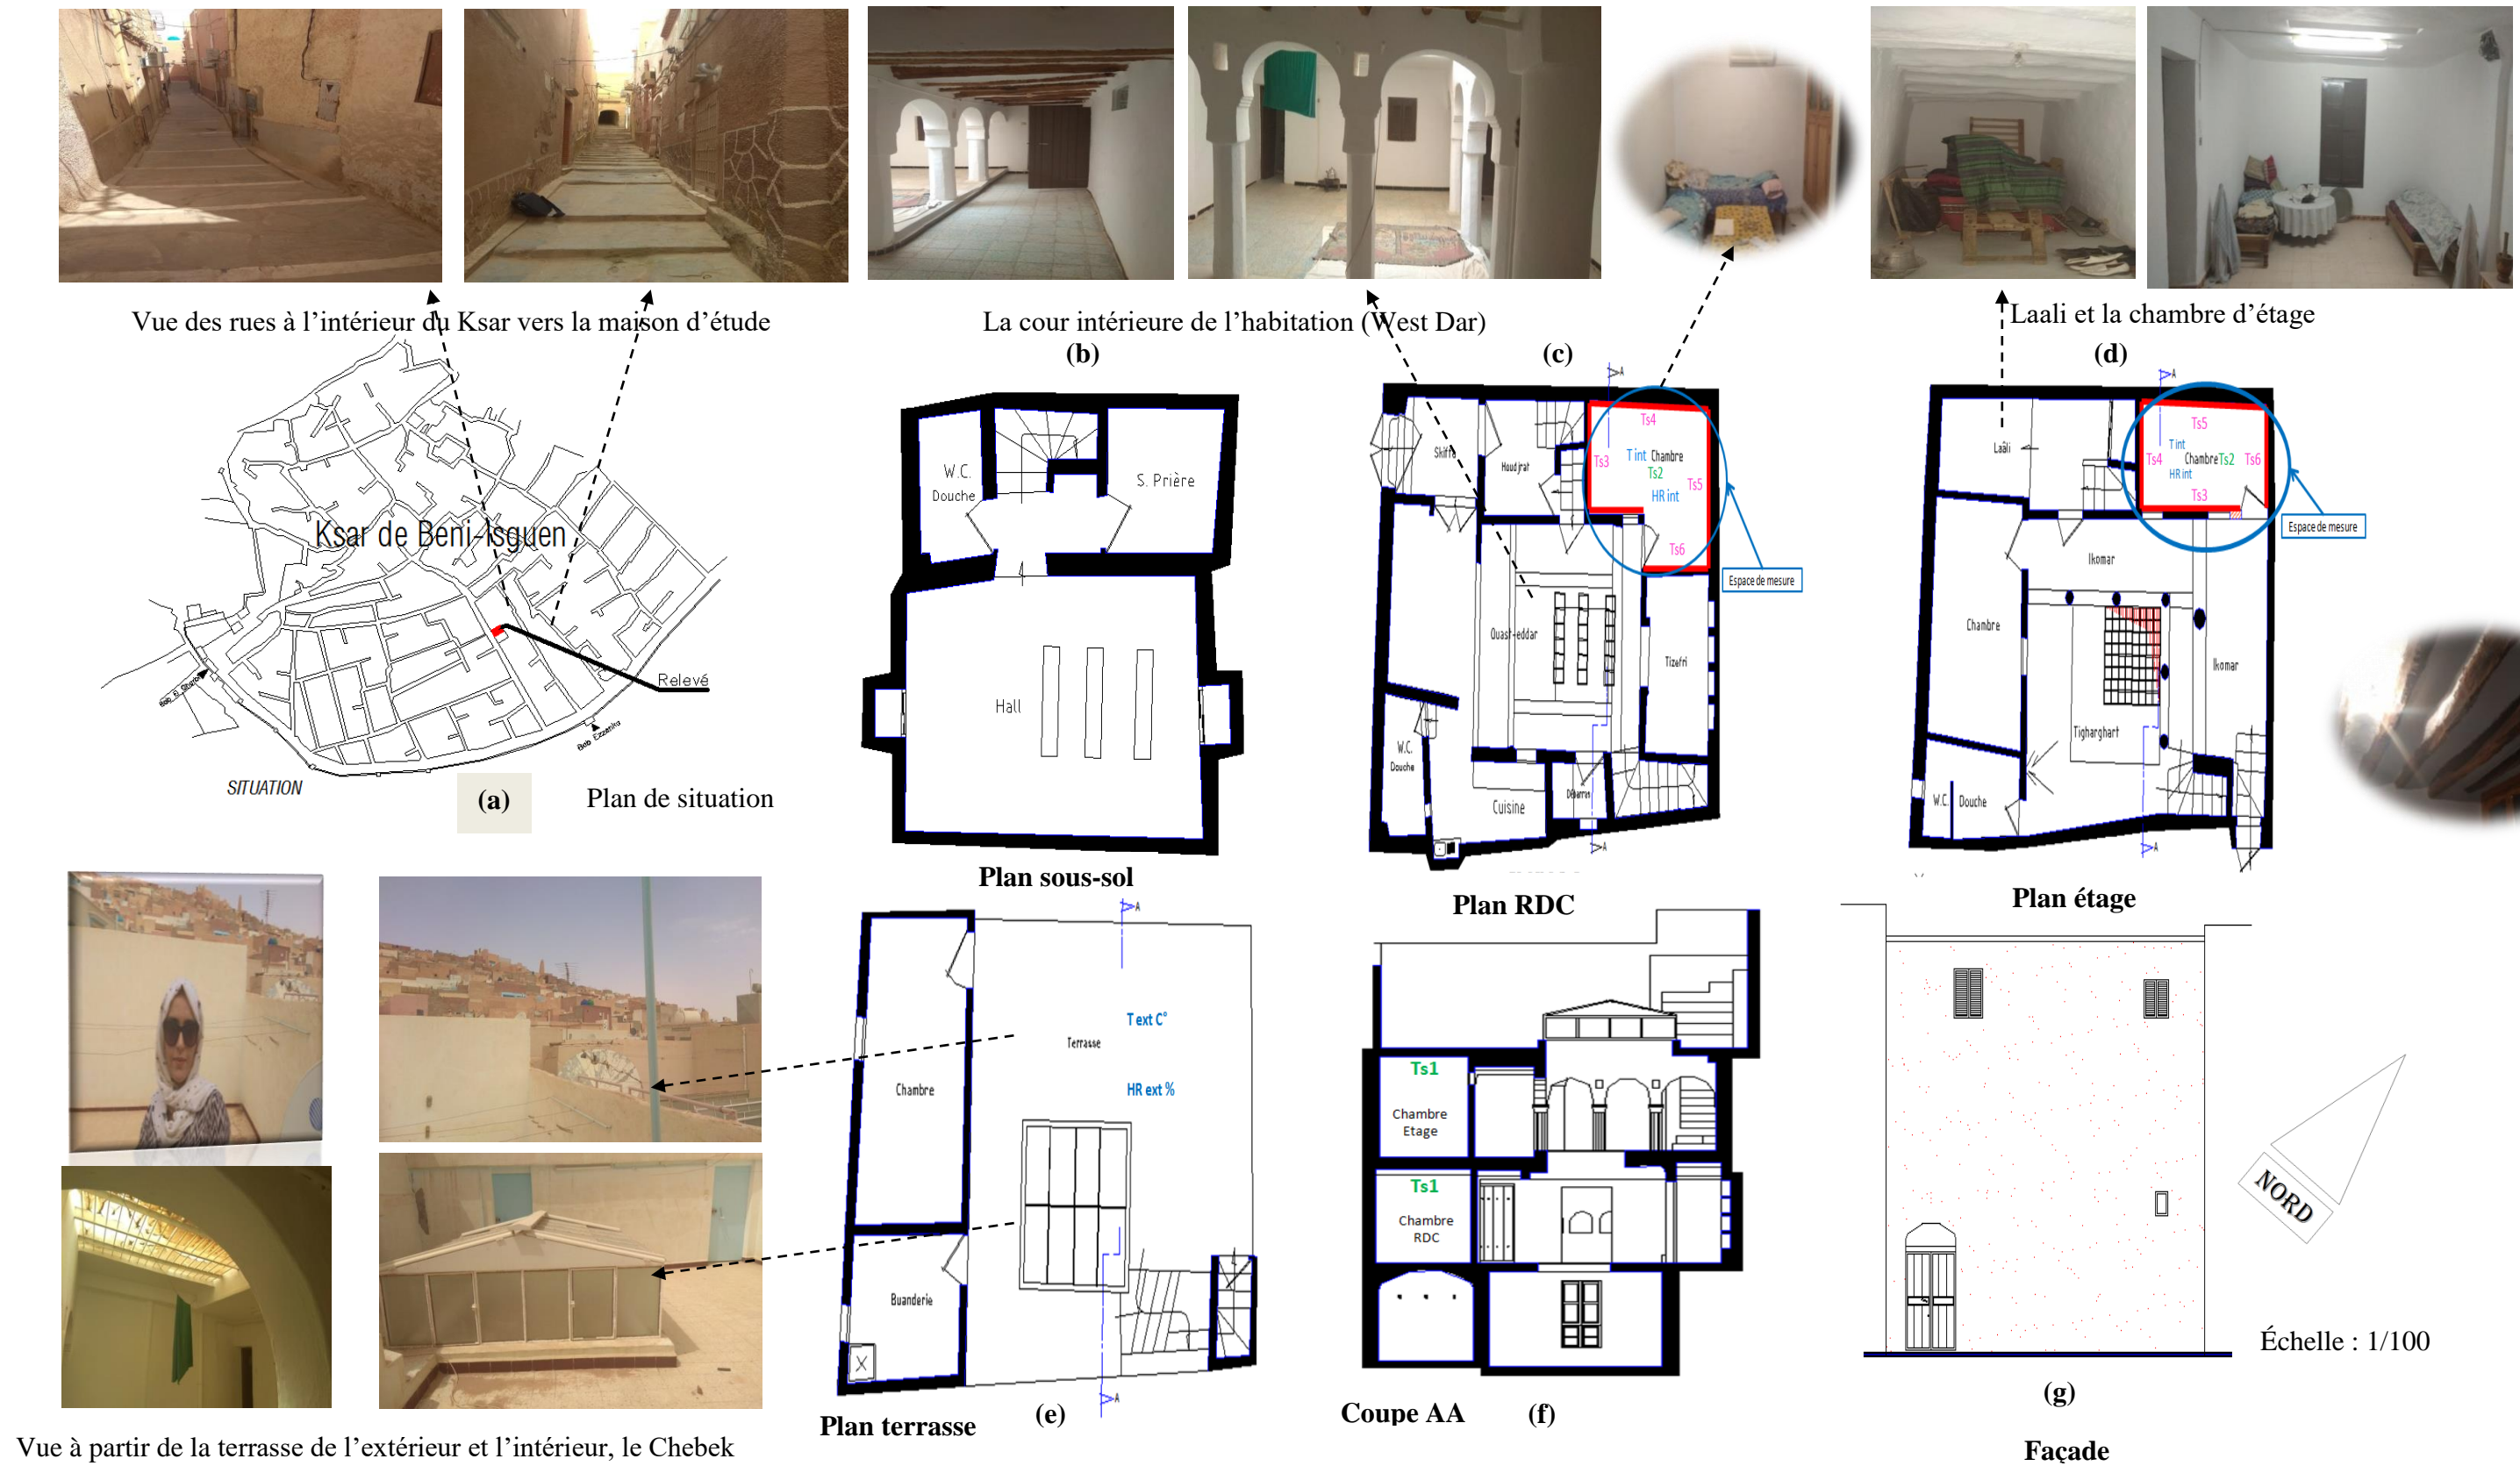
Plan de maison 1 avec photos : (a) Situation (b) Plan sous-sol, (c) Plan RDC, (d) Plan Étage, (e) Plan-terrasse, (f) Coupe AA, (g) Façade (Auteur, 2018)
